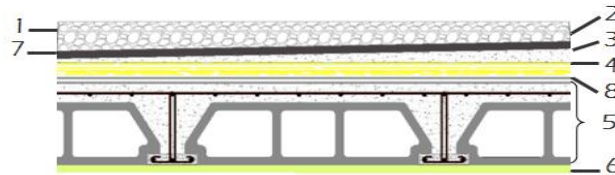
Coupe transversale du plancher terrasse inaccessible.
